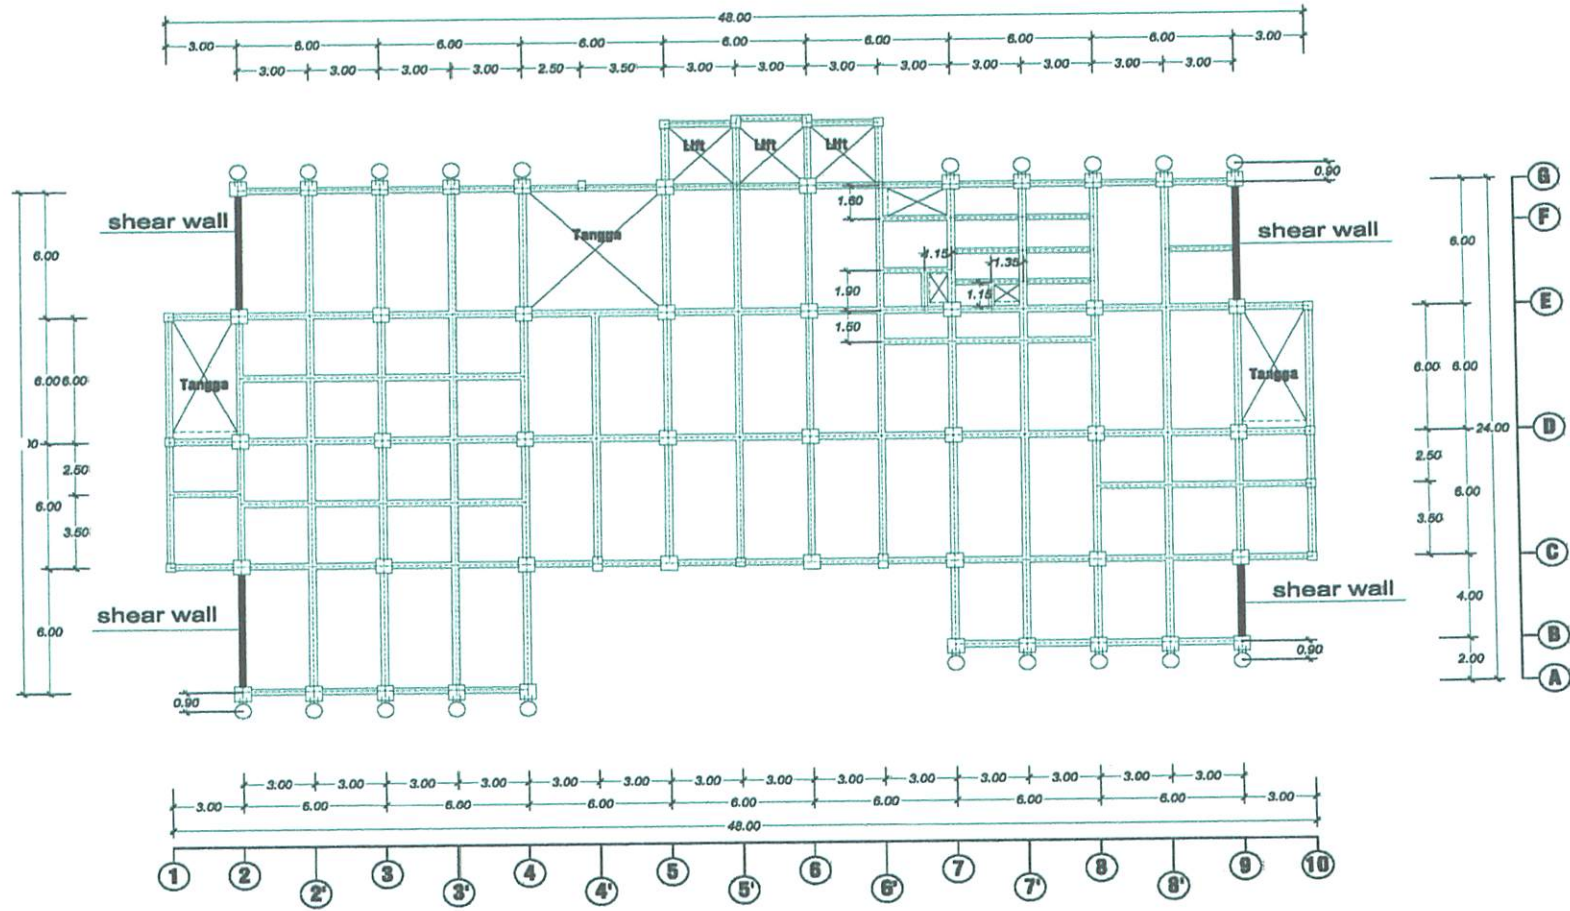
Denah Balok Dan Kolom Lt 5
